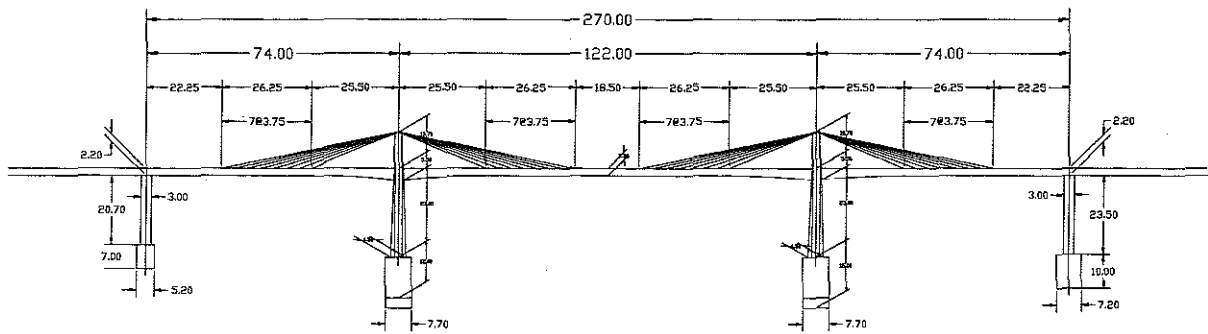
Alzado longitudinal del puente con pretensado extradadosado.
